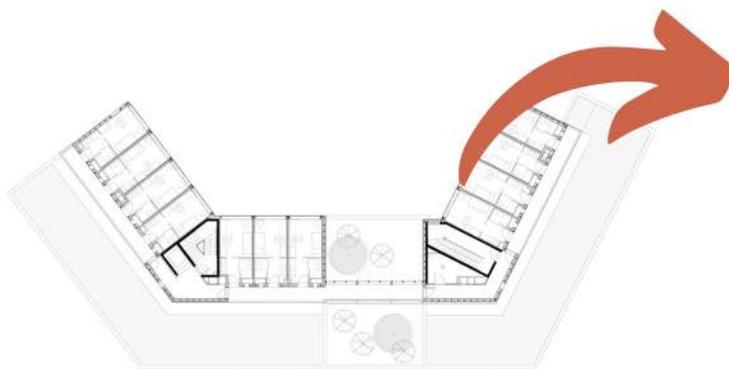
Planos de propuesta Lucien Cornill, A+Architecture, 2022
